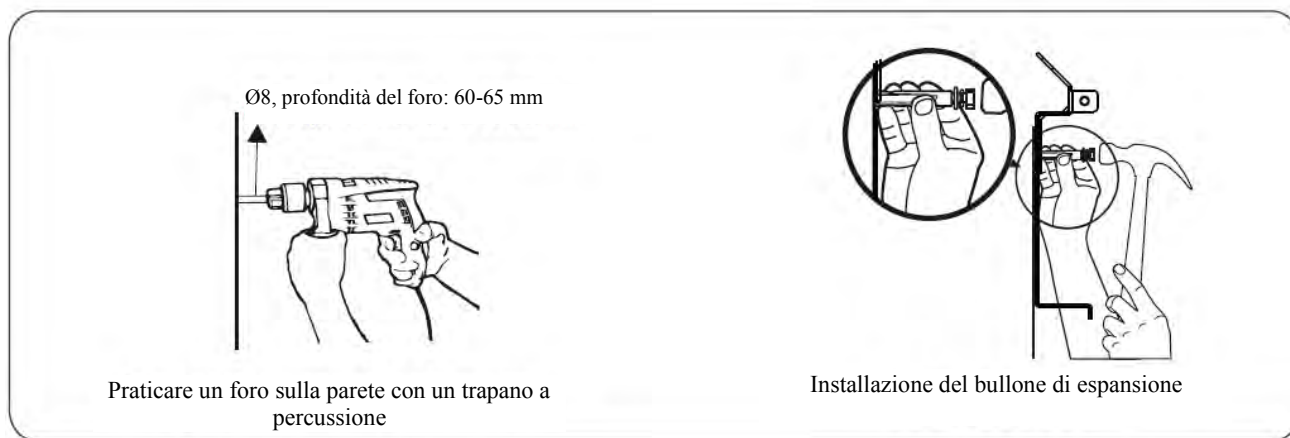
Esecuzione del foro e installazione dei tasselli a espansione (unità: mm)
